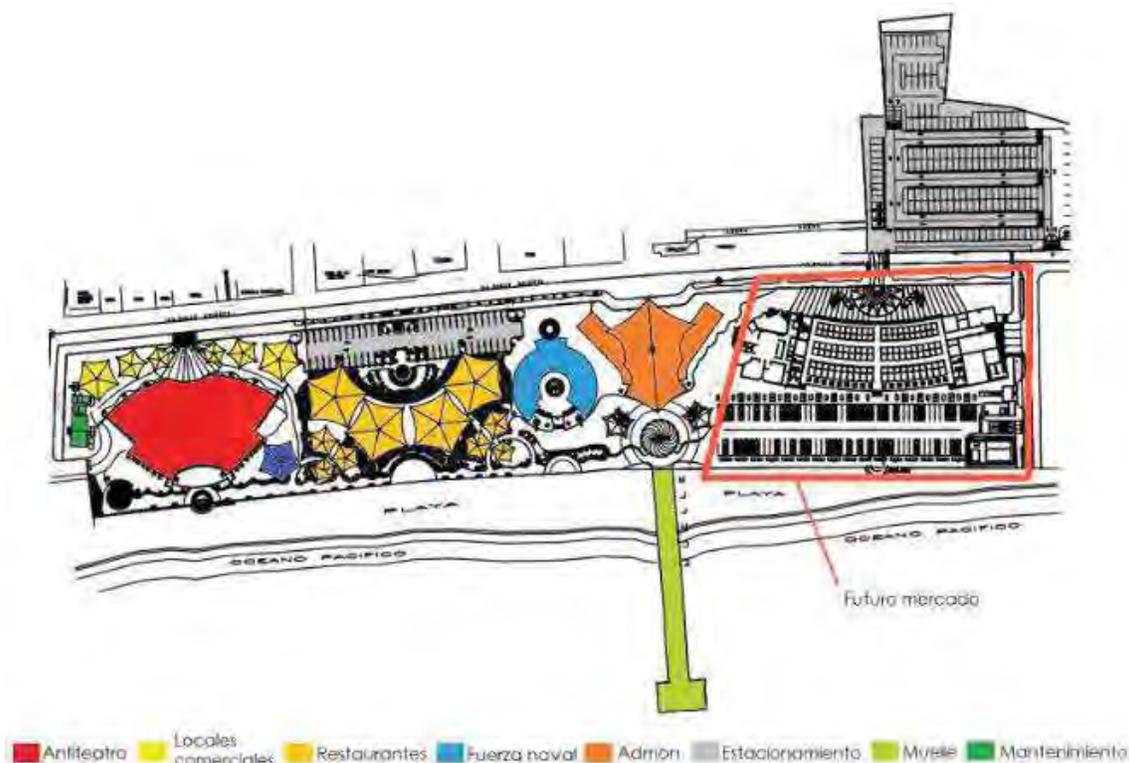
PLANTA DE CONJUNTO DEL COMPLEJO TURÍSTICO
